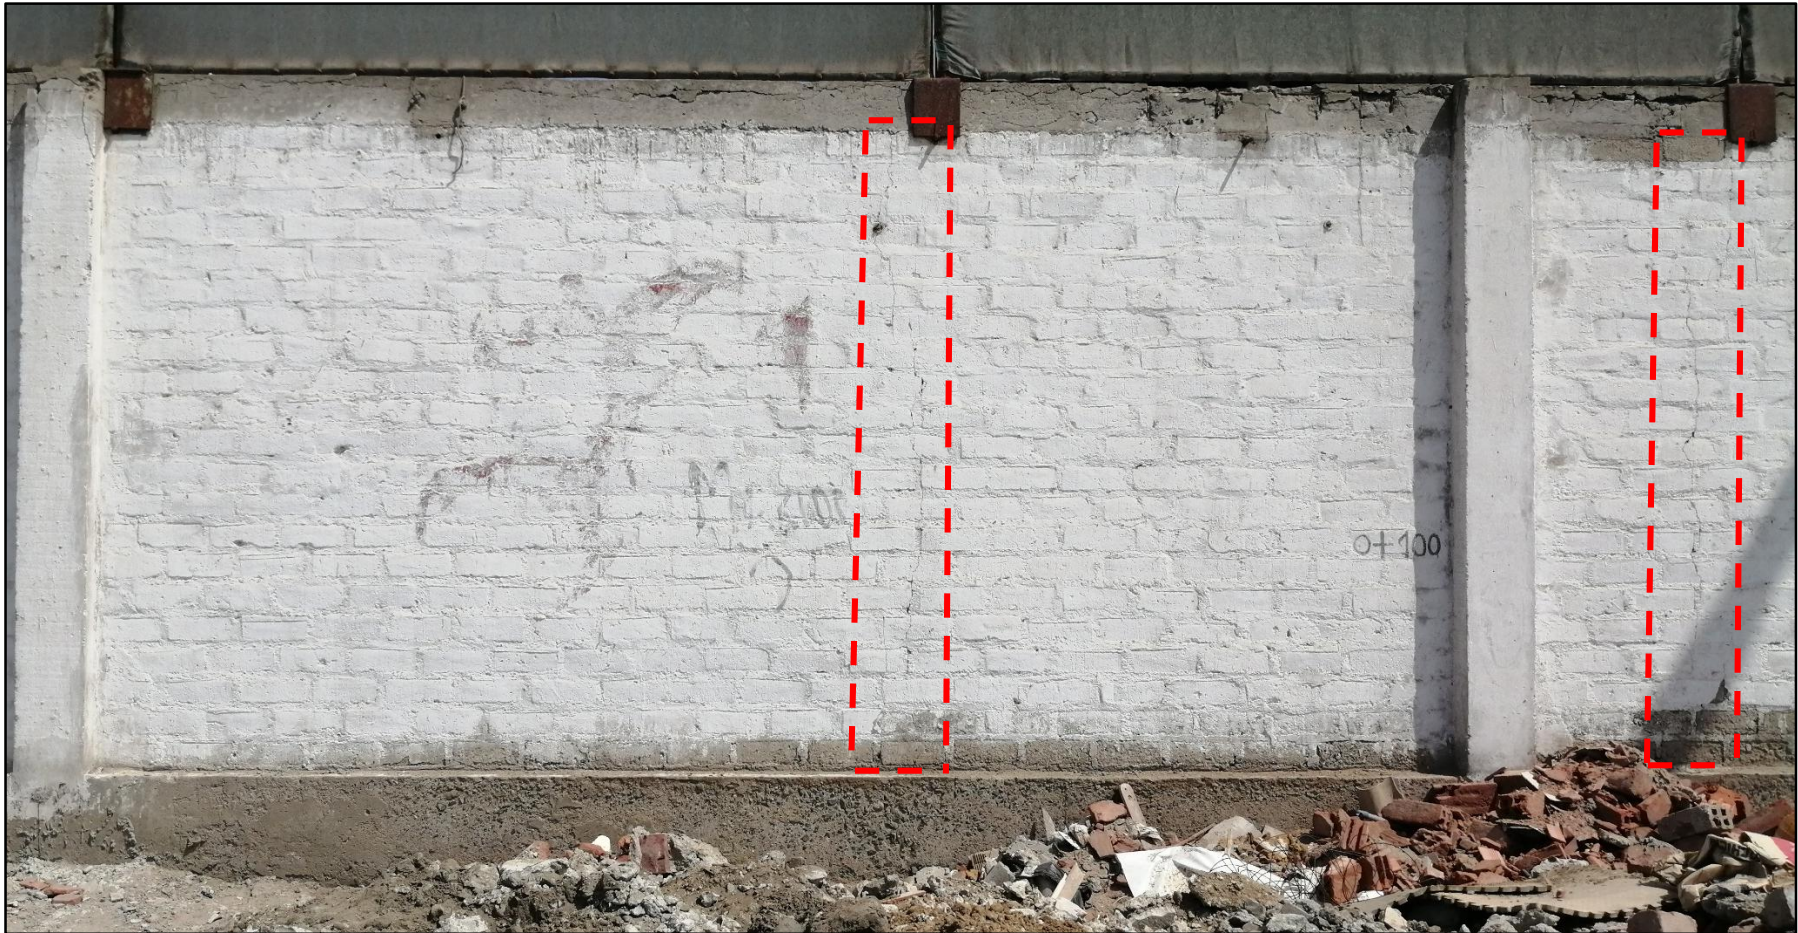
Muros de albañilería afectados por las fisuras en la UM-07.
